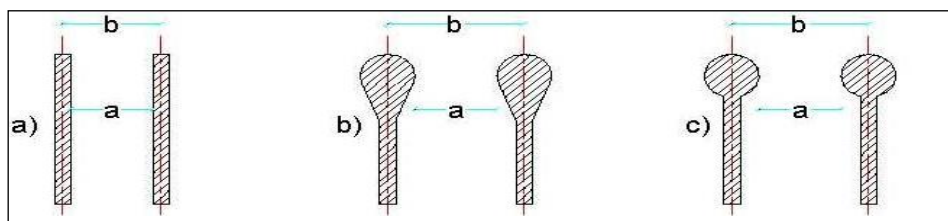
Tipet e shufrave të zgavrave të veprave të marrjes
